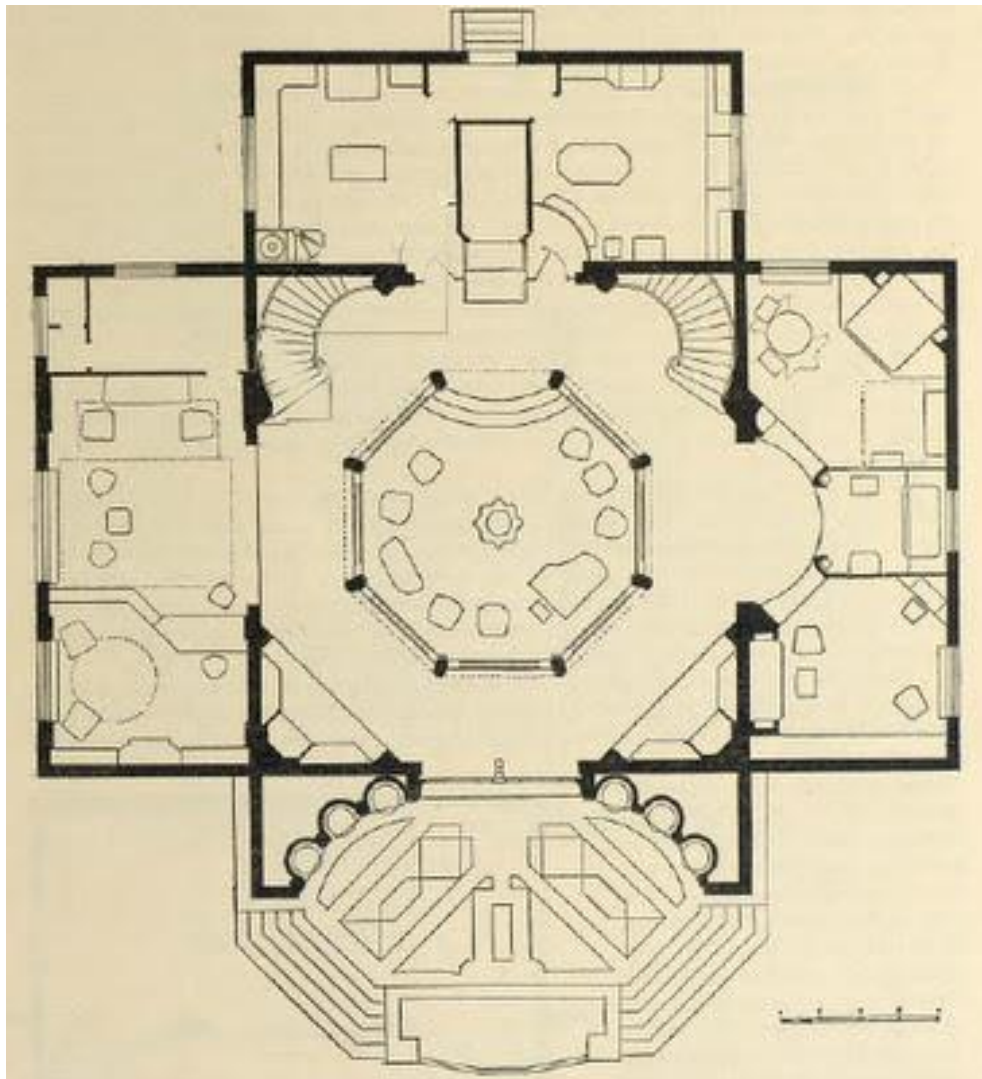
Planta del Pavelló dels Artistes Reunits, 1929
